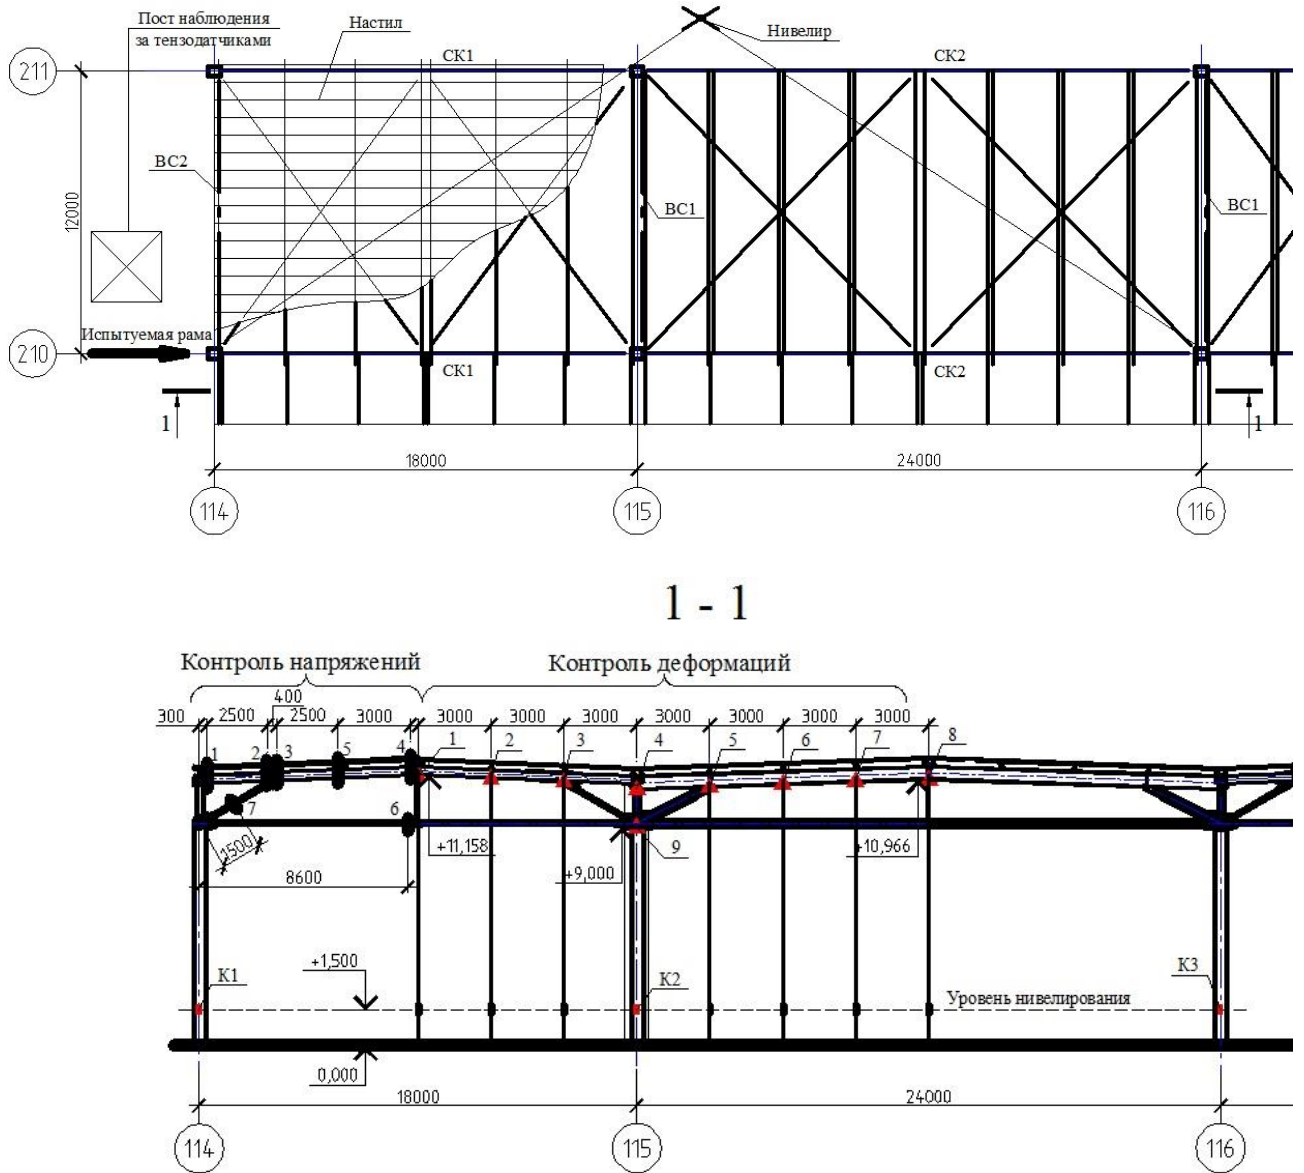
Схема испытаний балочных конструкций по оси «210»
